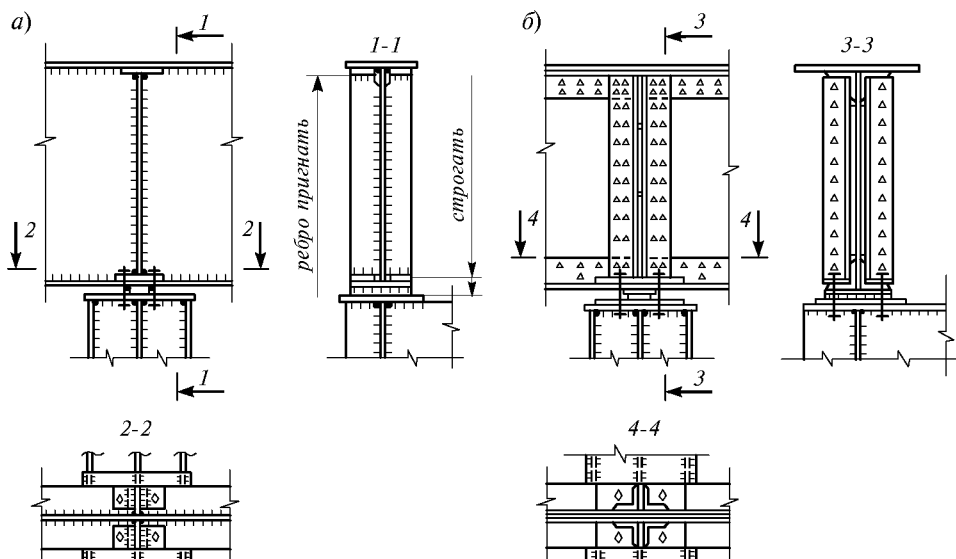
Опираие неразрезной подкрановой балки на стальную колонну
